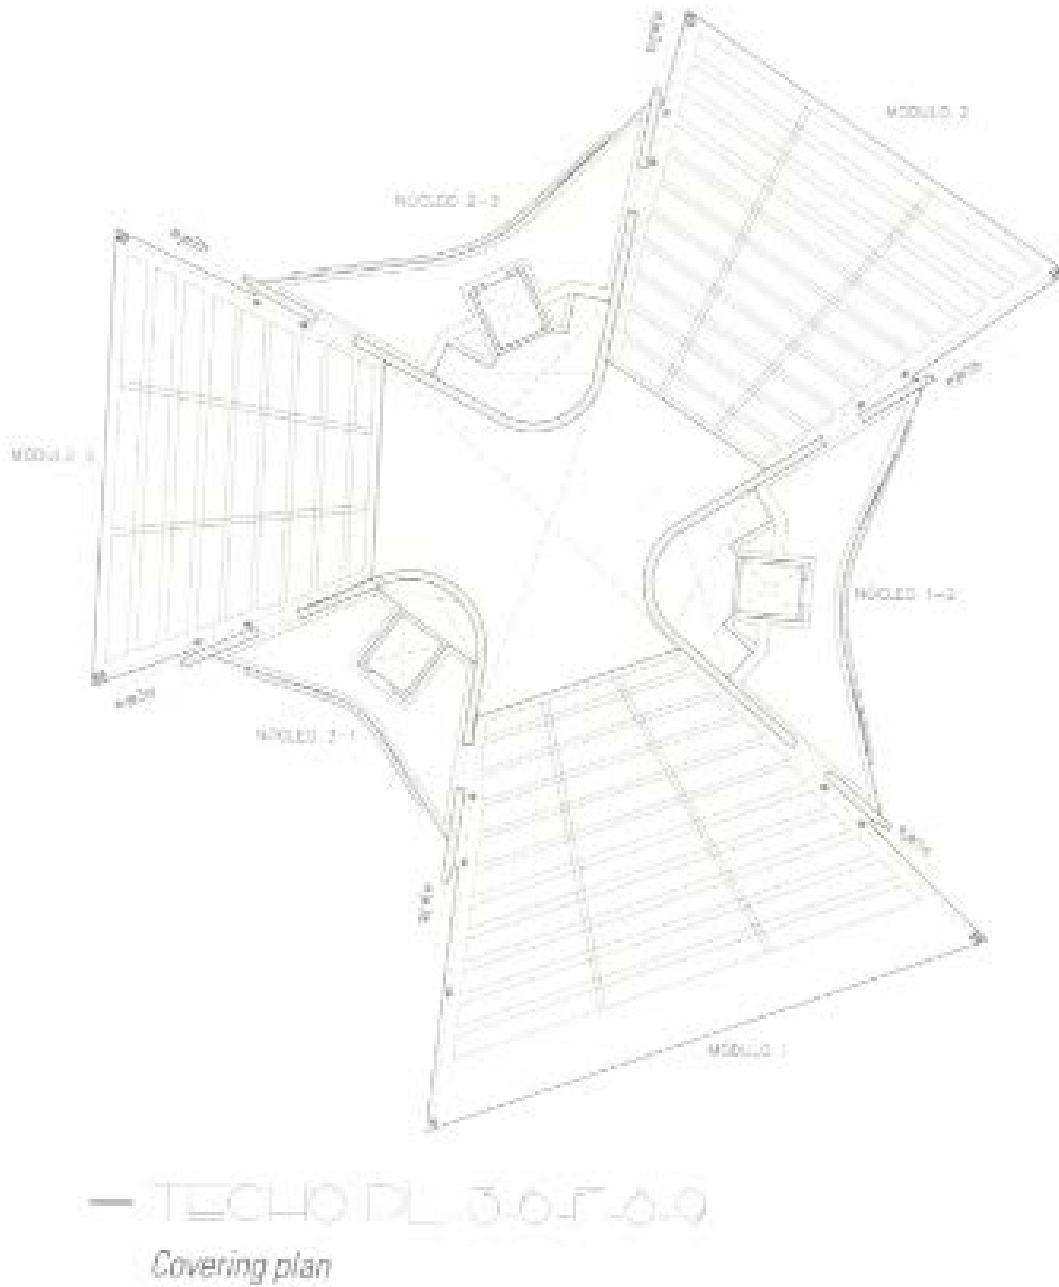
Detalle de la disposición de los forjados en la planta tipo. Documentos de Arquitectura nº 60. Revista del Colegio de Arquitectos de Almería.
